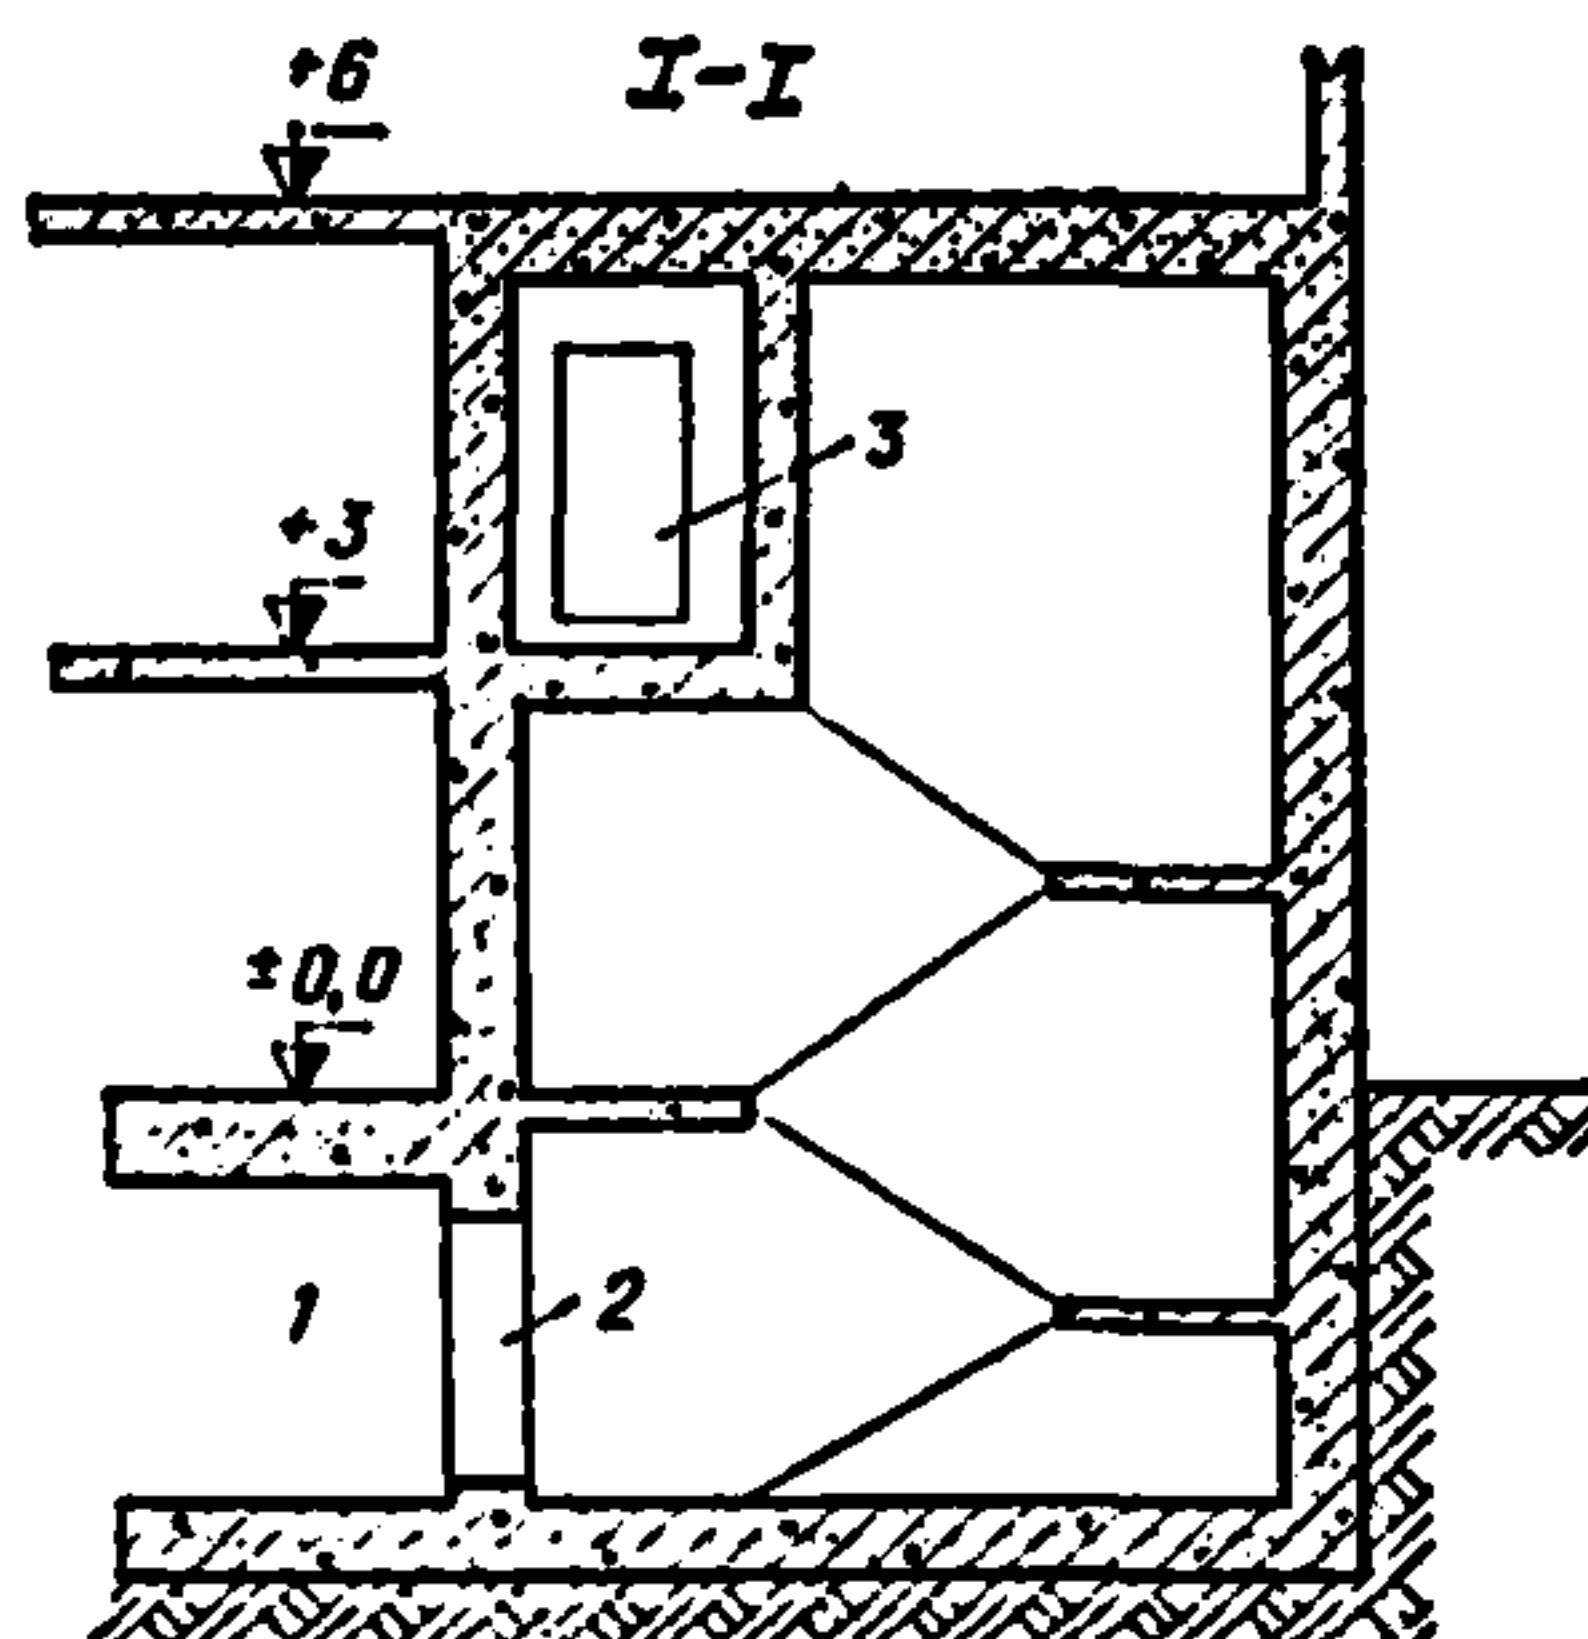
Схема расположения аварийного выхода при уровне грунтовых вод на 0,5—1 м ниже перекрытия
